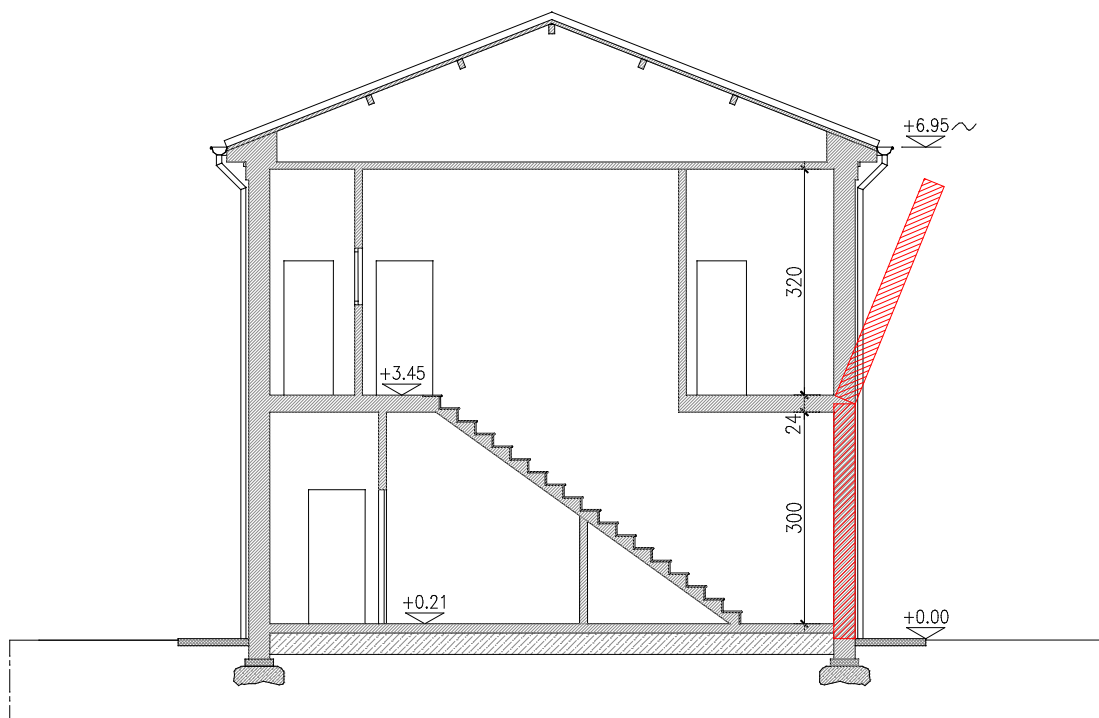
Palazzina C – SEZIONE – Meccanismo tipo #1
